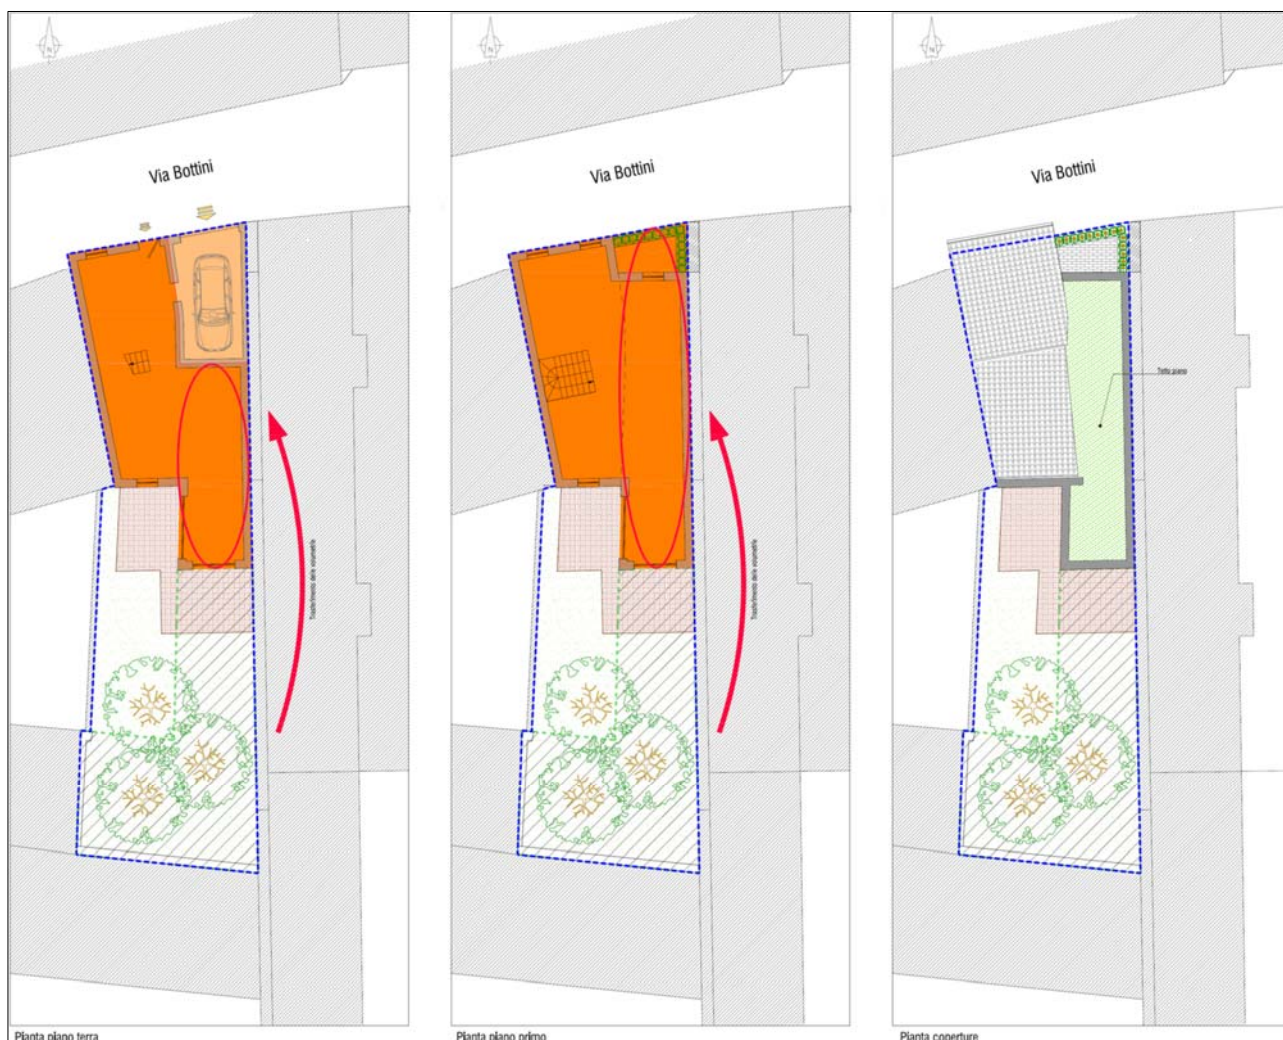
assetto planivolumetrico del piano attuativo in variante al PGT
